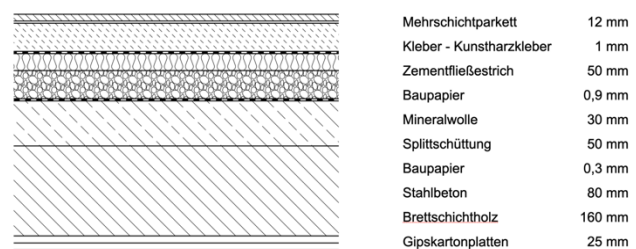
Detail Deckenaufbau Holz-Beton-Verbunddecke (maßstabslos)
